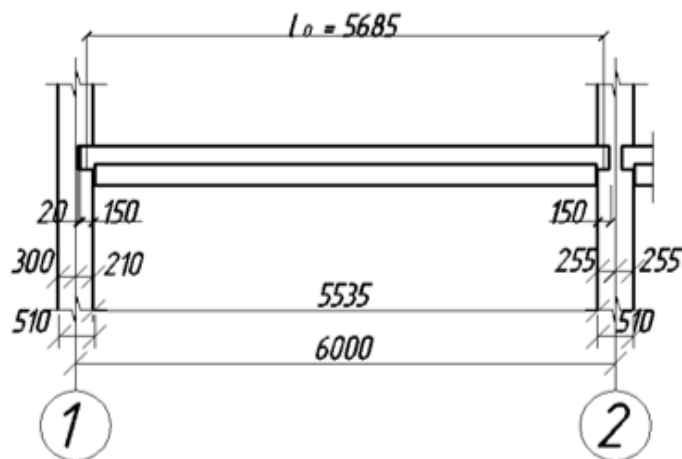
Схема для определения расчетного пролета ригеля
